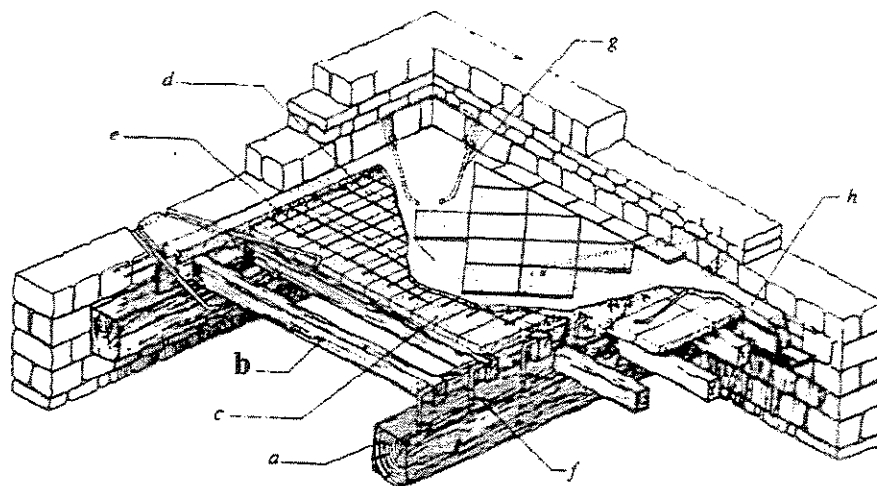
Exemplo de um piso concreto-madeira utilizada, na Europa, em construções de alvenaria
